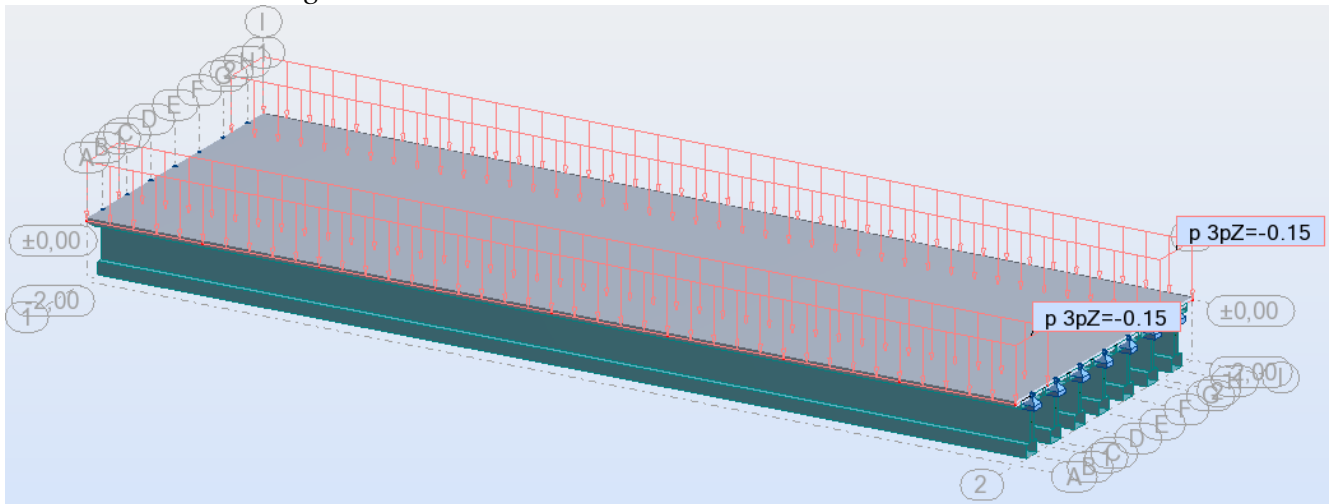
chargement sous le poids des surcharges sur trottoir.
